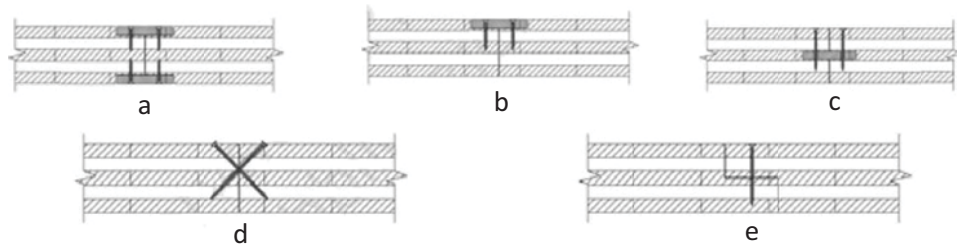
Sistema meccanico di collegamento parete – parete di pannelli X-LAM. ⁽¹⁰⁾
